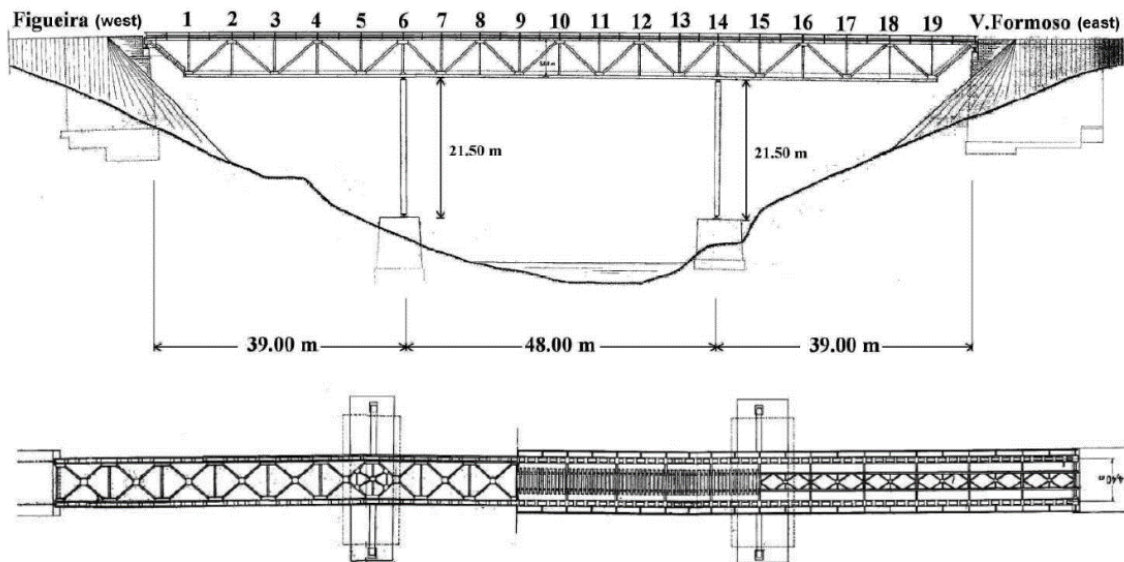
Representação técnica da Ponte do Trezói: elevação e vista no plano [73, 83]
